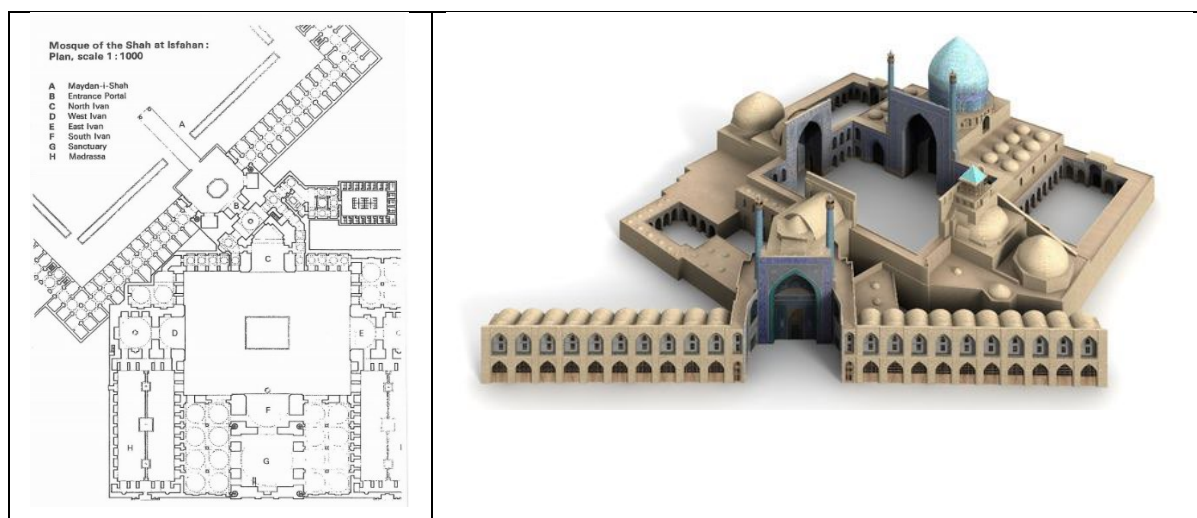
La Masjed-e Shah. Planimetria e Modello tridimensionale
